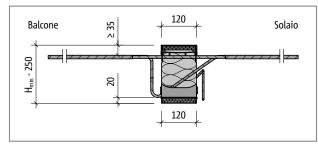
Schöck Isokorb® tipo da KXT55 a KXT100, REI120: sezione dell'elemento
